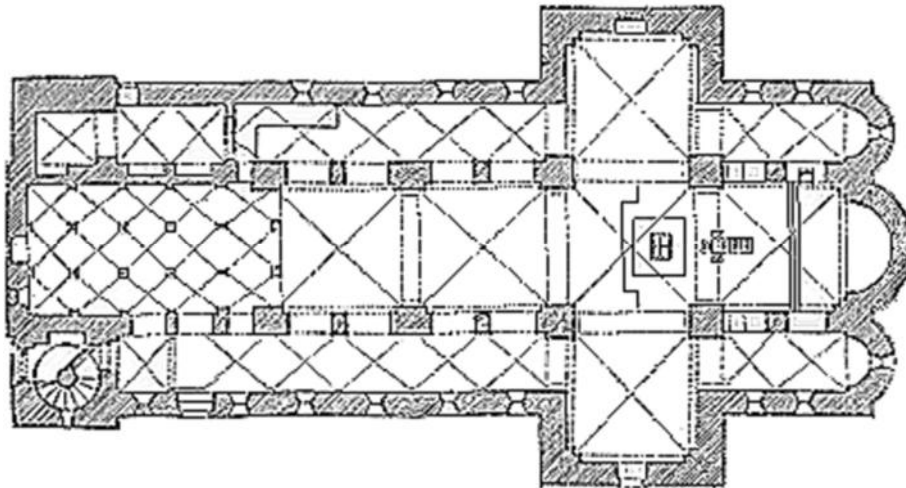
Klosterkirche Lippoldsberg – Grundriss ([www.klosterkirche.de](http://www.klosterkirche.de))
